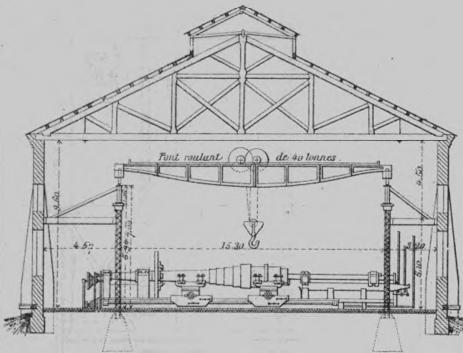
Coupe transversale de la halle des canons de 304^m/m 8.Fig. 4. Coupe transversale de l'atelier des Canons de 152^m/m 4. et 203^m/m 2.Fig. 2. Plan de la halle des canons de 304^m/m. 8.
